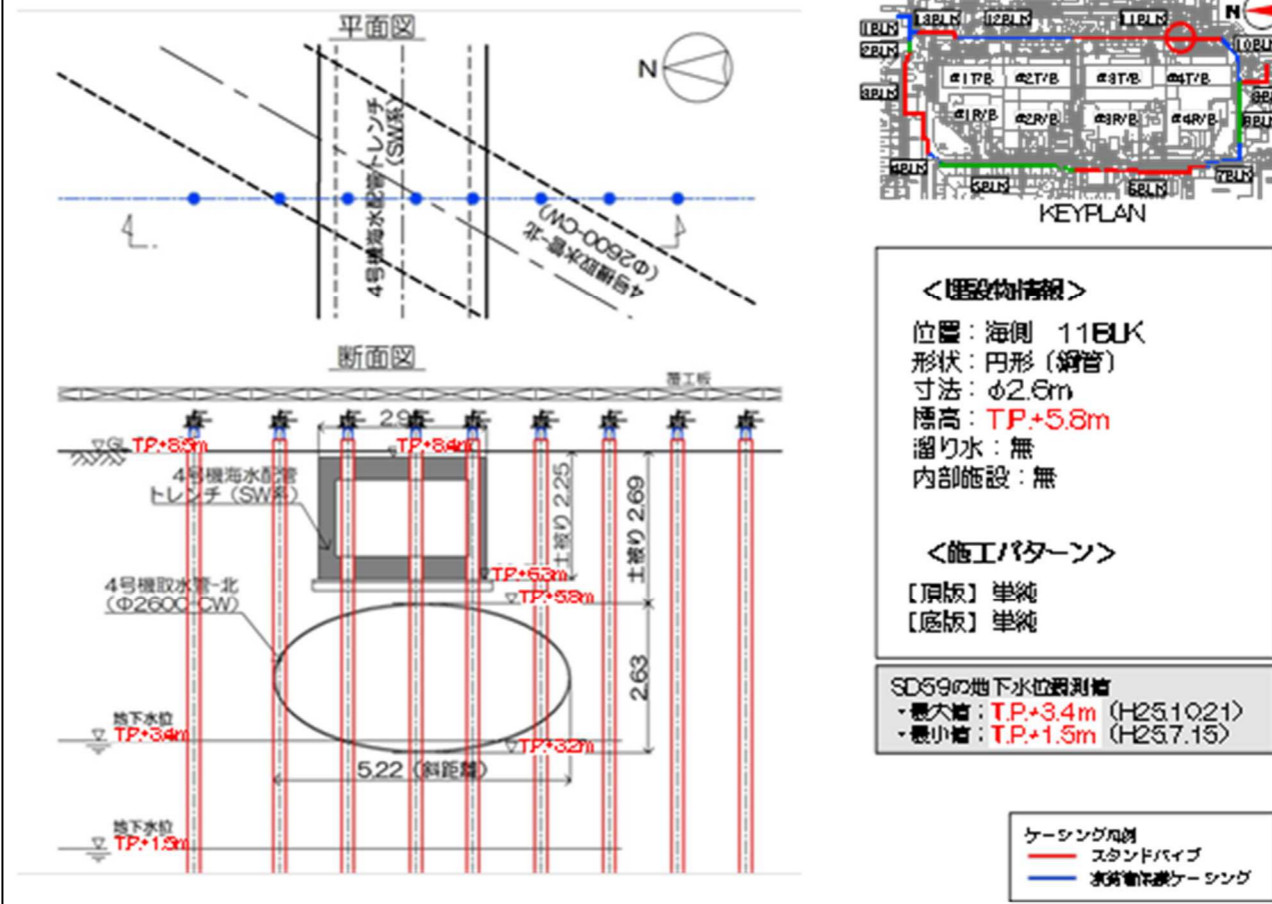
【11-3】4号機取水管-北 施工方法(貫通施工)
